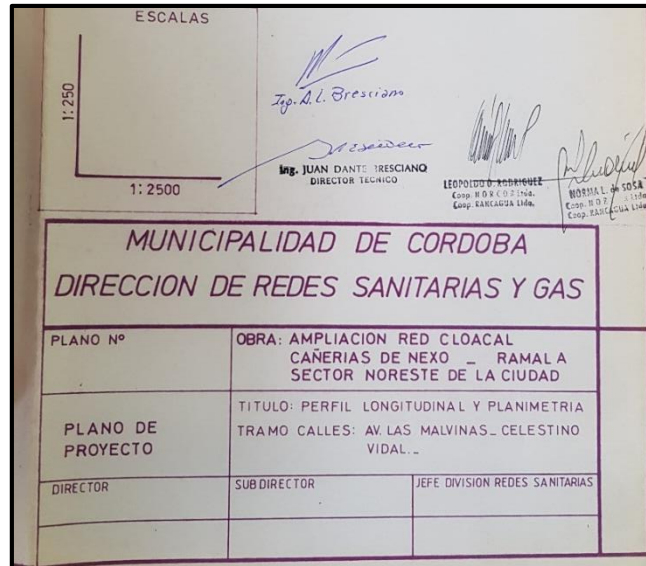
Plano de perfil longitudinal y planimetría Nexo ramal A.
